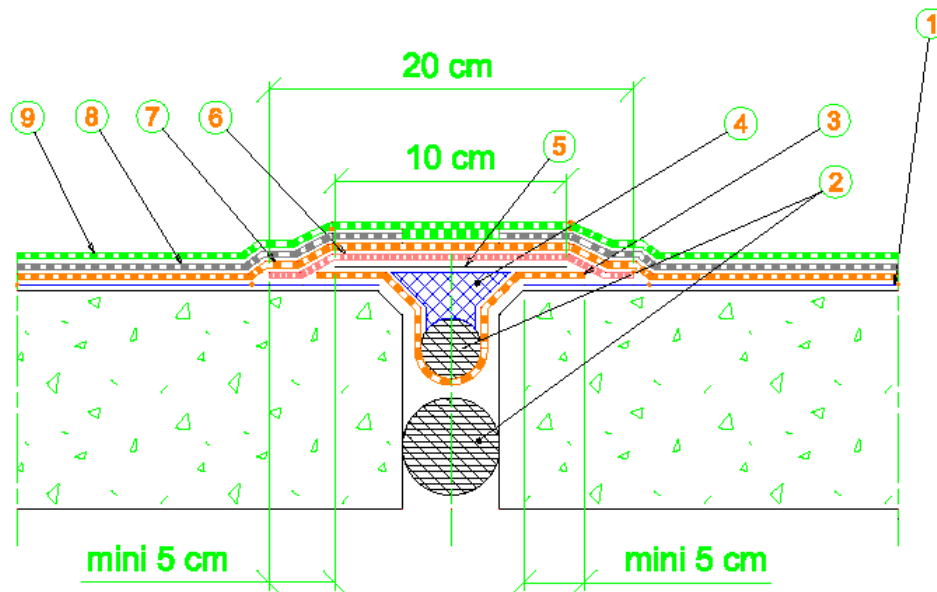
fissures et joint de construction (hors joint de dilatation)
